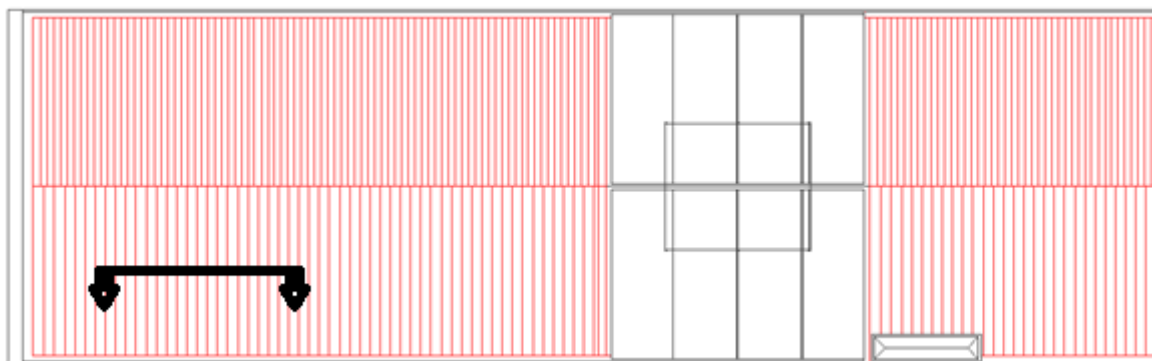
Marcação da zona de corte da cobertura na planta (Adaptado das peças desenhadas do Edifício do Caso de Estudo)
